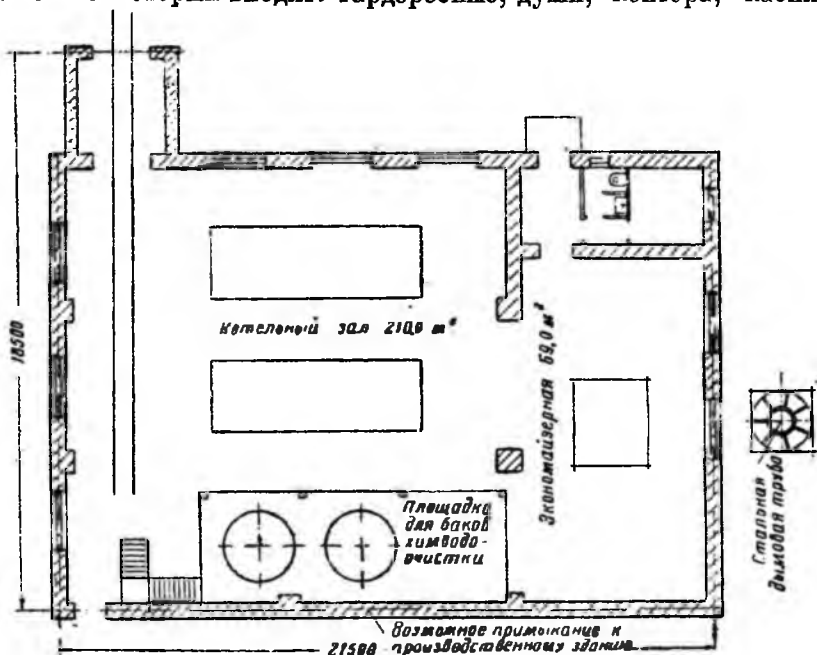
План отопительной котельной на два котла Шухова-Берлина
